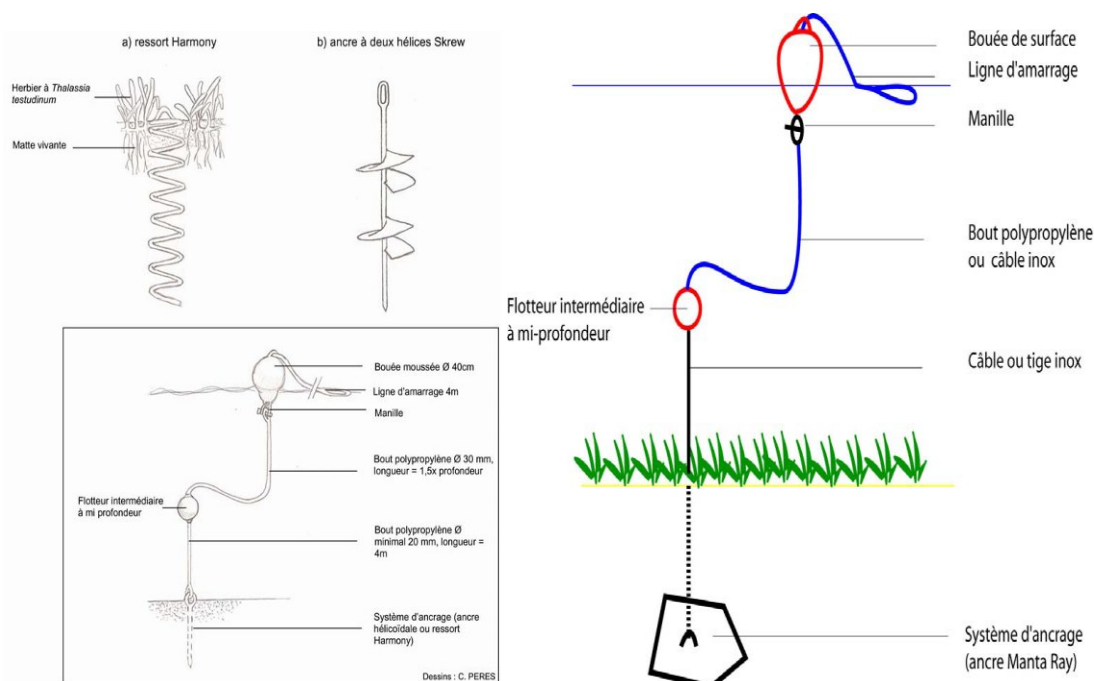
Schéma d'un mouillage sur ancre à vis et manta ray (Source : 3AME, 2008)
